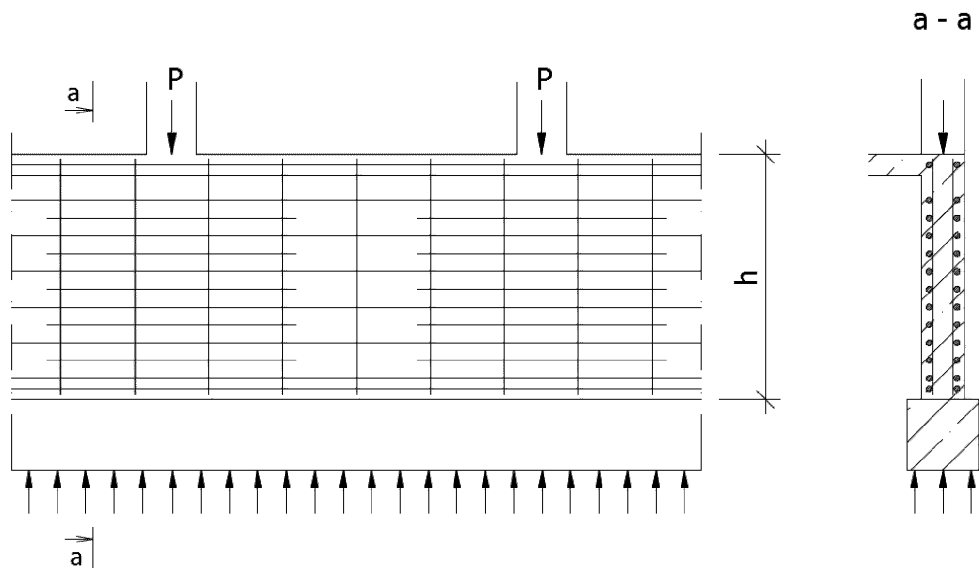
Армирование подвальных стен, находящихся под действием сосредоточенных нагрузок
